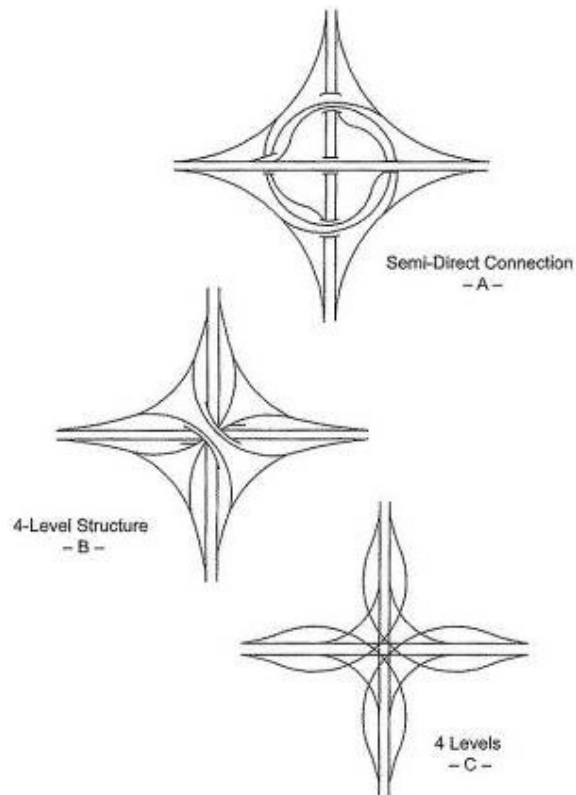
Distribuidores direccionales con estructuras multiniveles
